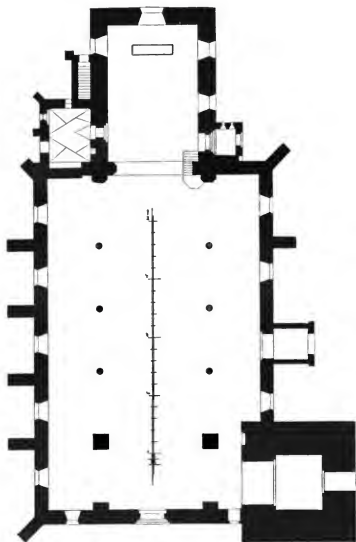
Grundriß der Kirche zu Fr.-Holland.
